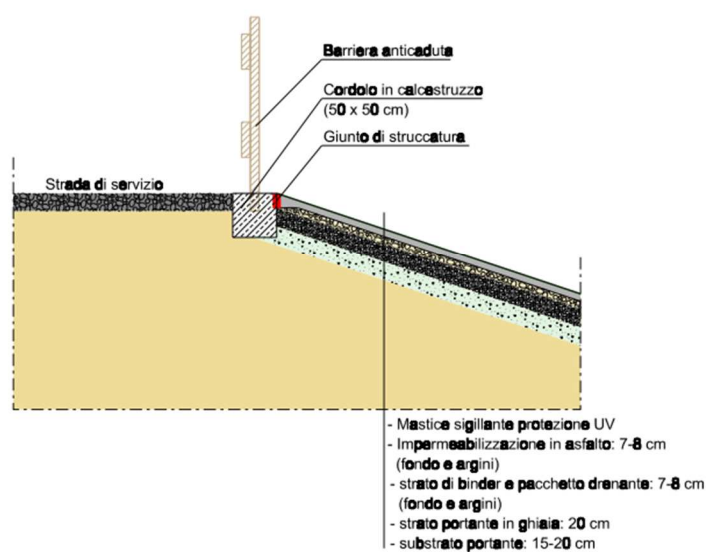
Dettaglio del sistema di impermeabilizzazione (estratto Tav. PD-EP.16.2).
